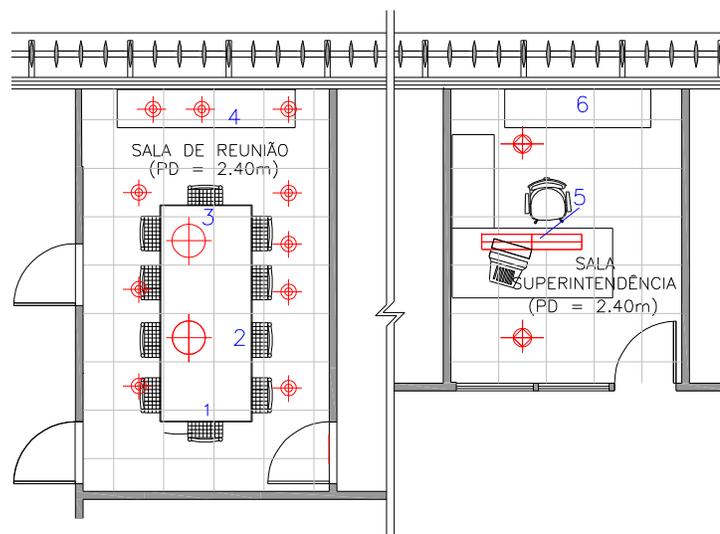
Planta de Ambientação – 11º pavimento – Salas de Reunião e Superintendência
